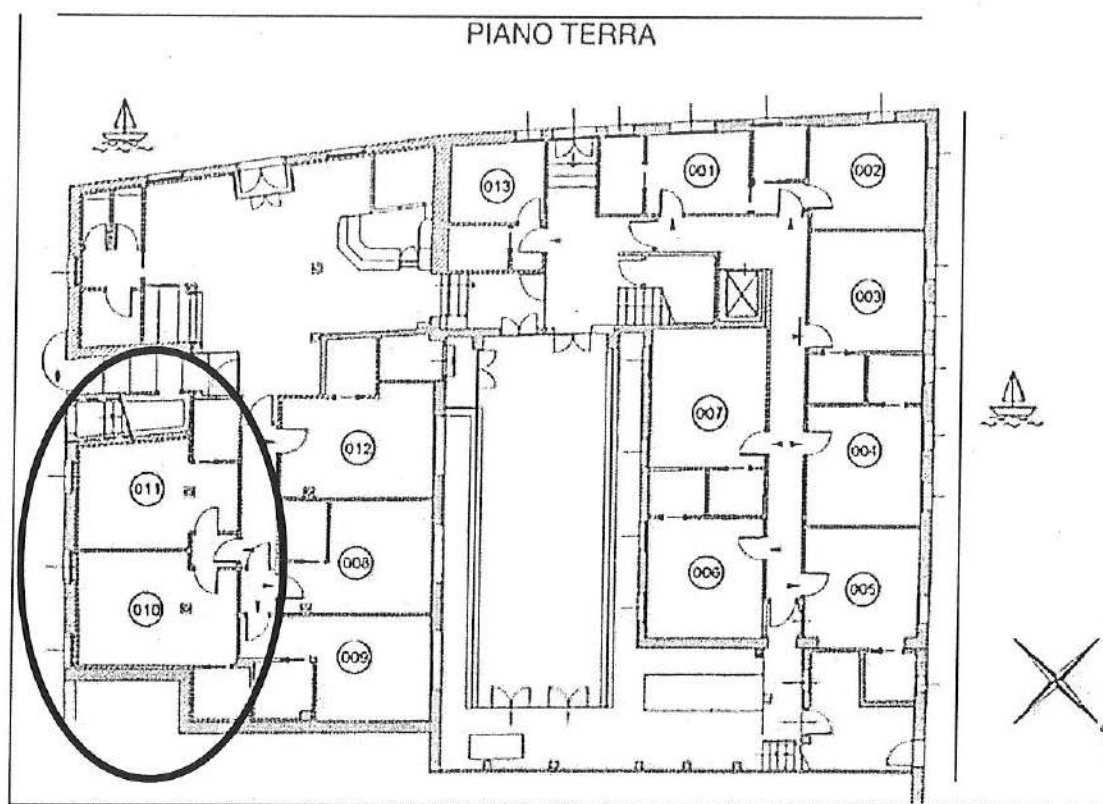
Pianta piano terra del fabbricato, con indicazione (ovale nero) delle due suite assegnate alla comproprietà in oggetto
